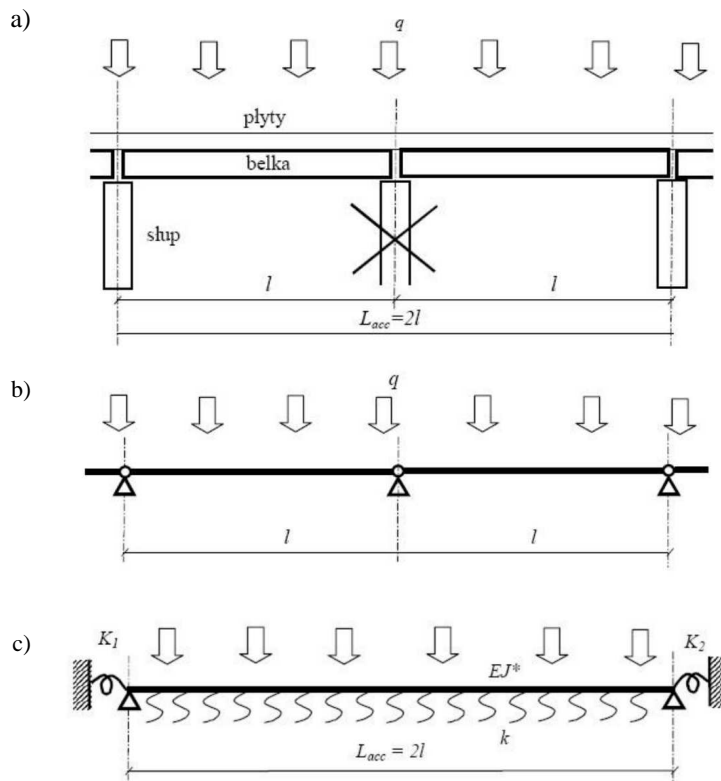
Model globalny prefabrykowanej konstrukcji szkieletowej
